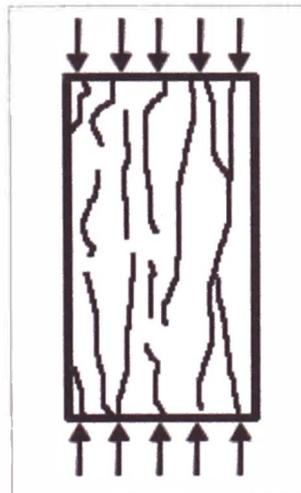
Fisuras por compresión excesiva de un elemento.
